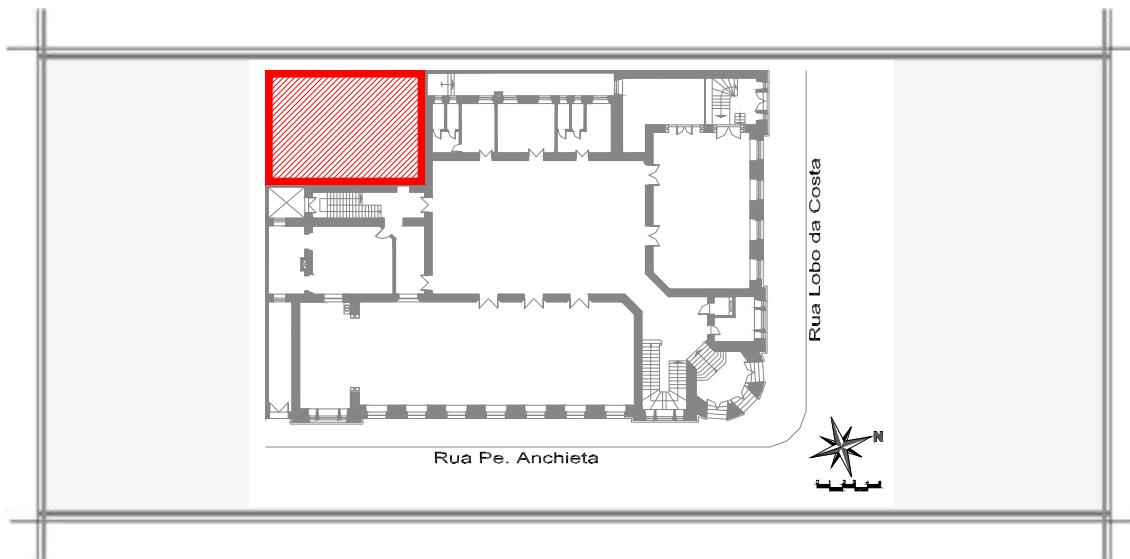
Planta Baixa 1º Pavimento. Desenho: Cristiane Müller.
